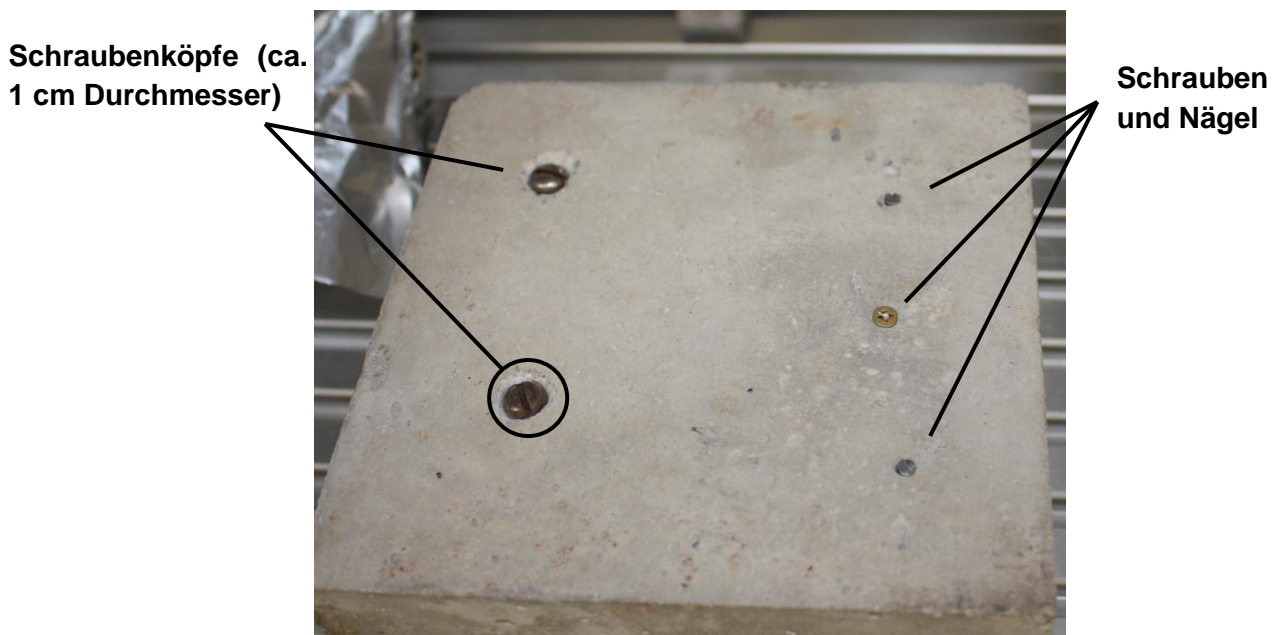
mit Schrauben und Nägeln präparierter Betonstein
